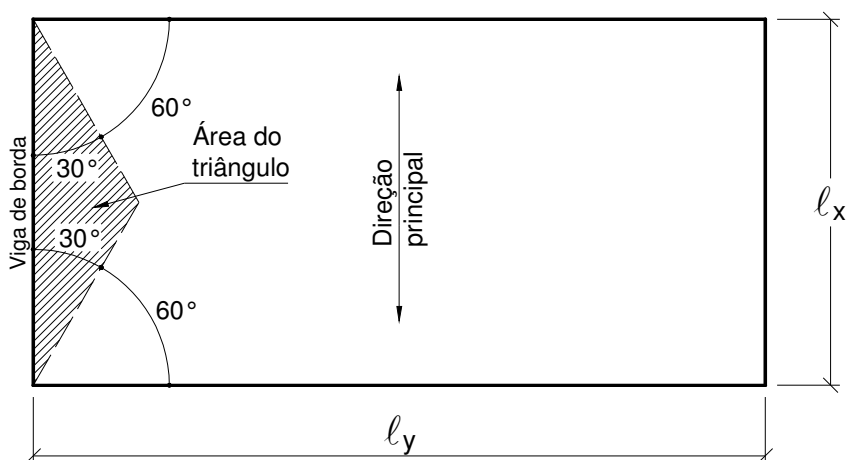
Carga nas vigas paralelas à direção principal da laje armada em uma direção sob carregamento uniformemente distribuído.
